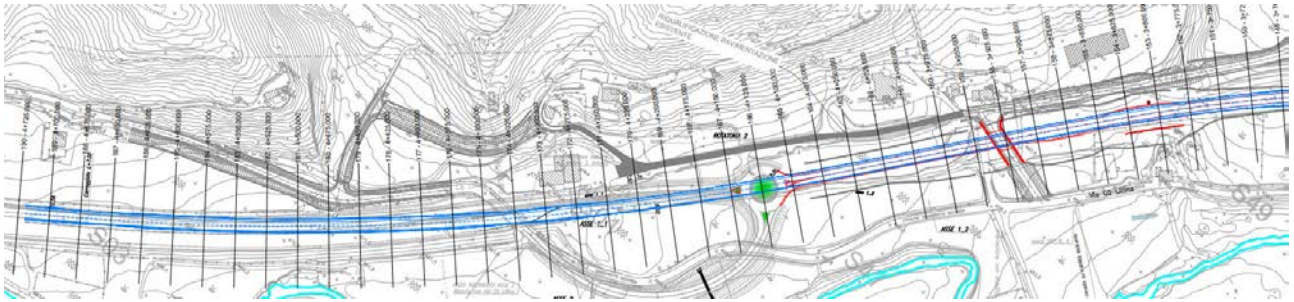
planimetria sezione tipo B – continuità con lotto precedente
